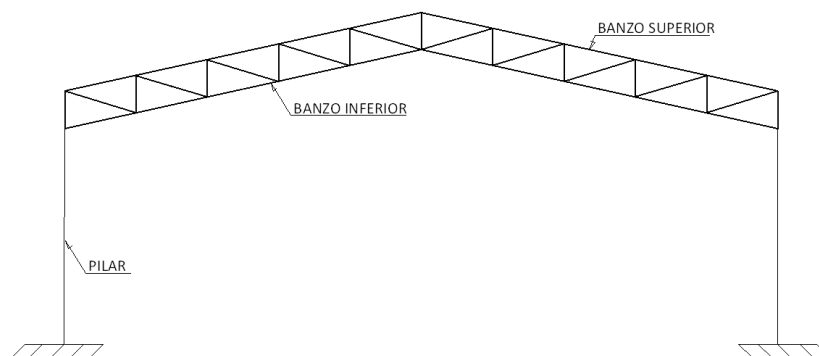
Pórtico treliçado – banzo paralelo.
